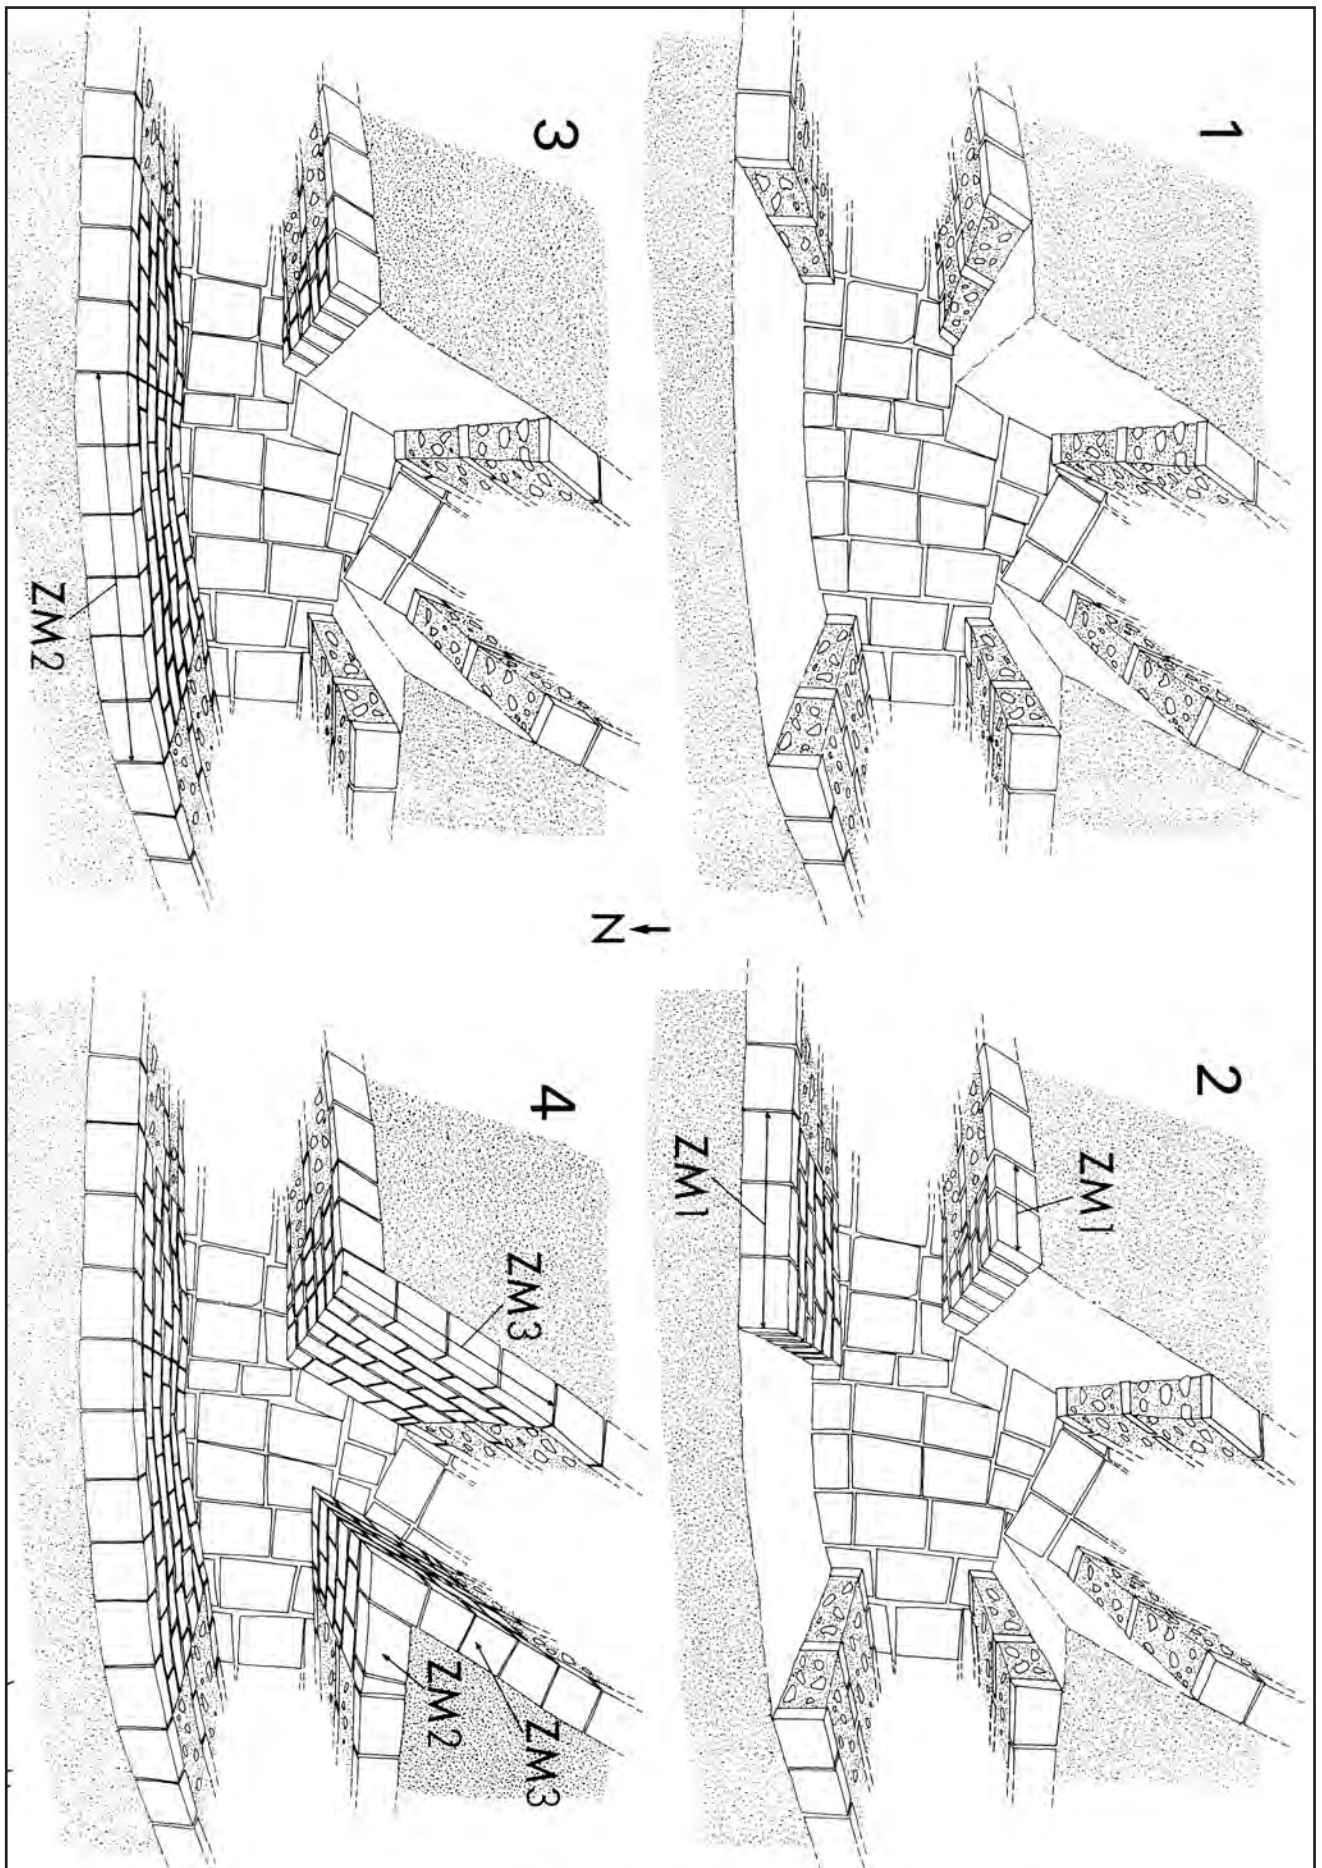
Reconstrucción del proceso constructivo de la unión del canal n° 1 con el canal n° 4.
